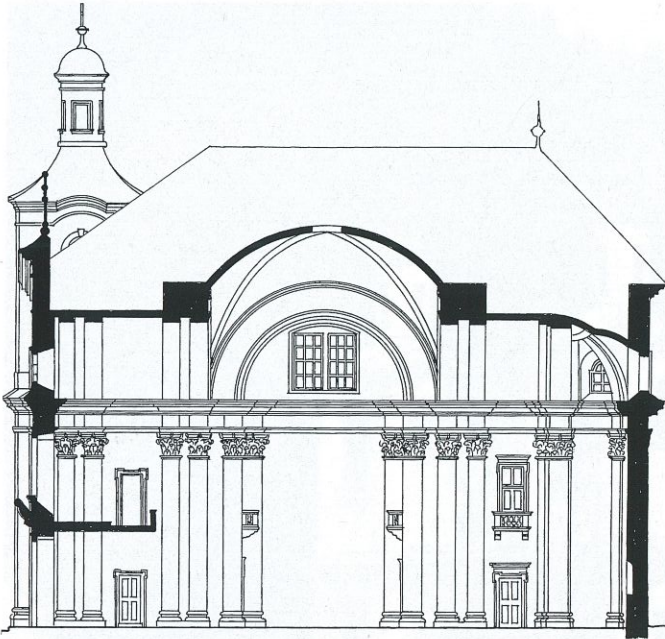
(Grundriß, oben) und 9b (Schnitt) der Kirche nach ÖKT.
